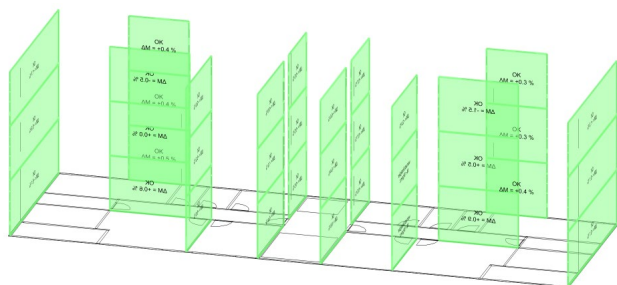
Nachweis der Aussteifung mit Brettsperrholzwänden
